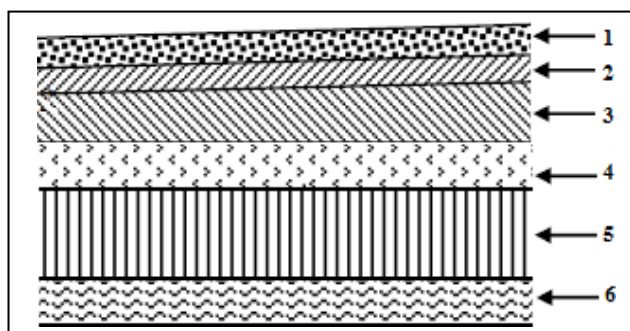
Charges permanentes du plancher T-I à dalle pleine
